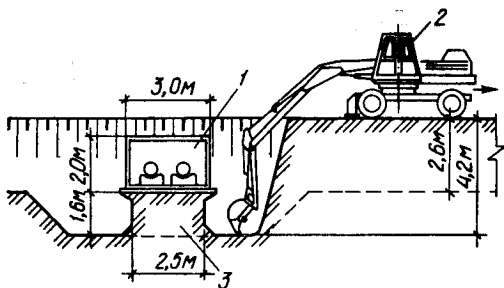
Разработка грунта в траншее, пересекающей инженерные коммуникации, гидравлическим экскаватором:
